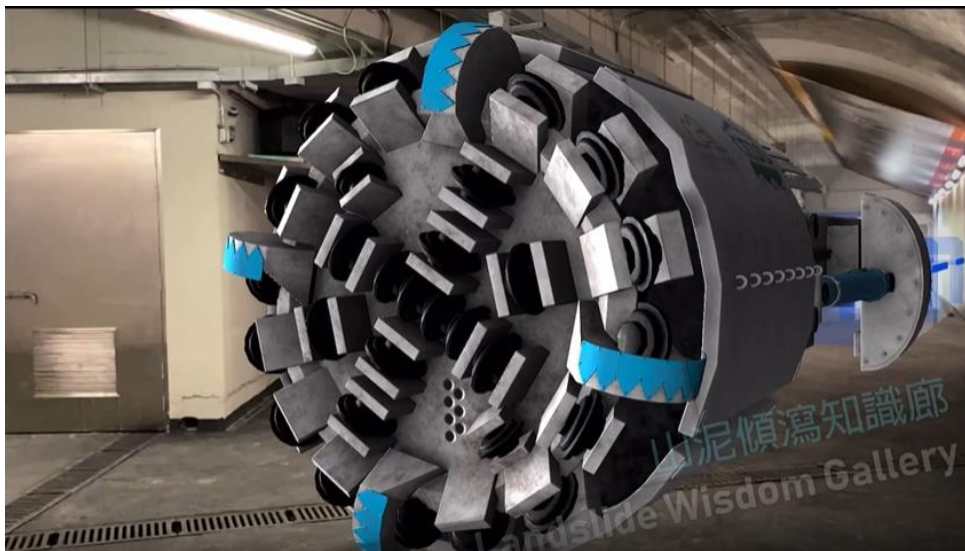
Imagen esquemática del taladro utilizado en la construcción de las galerías de drenaje
